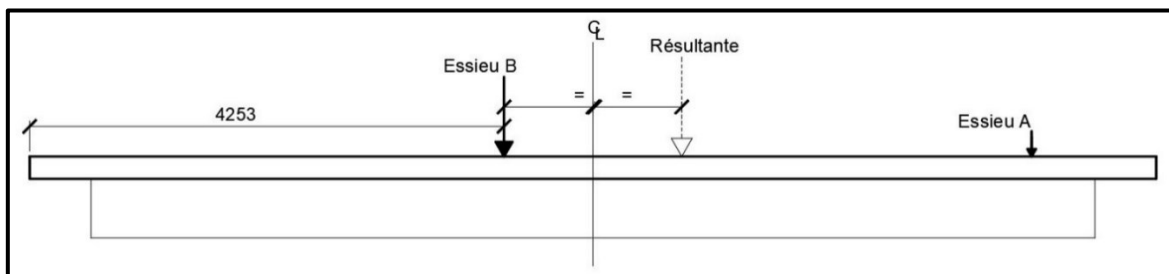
Position critique du camion H20-44 sur le pont (coupe transversale)
